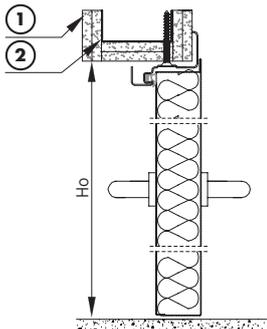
Montage an die Mauer der einflügeligen Türen mit Eckzarge - Vertikalschnitt
